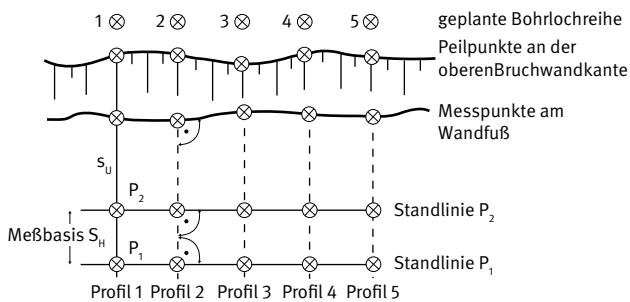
Grundriss-Vermessung mit dem Handgefällmesser
